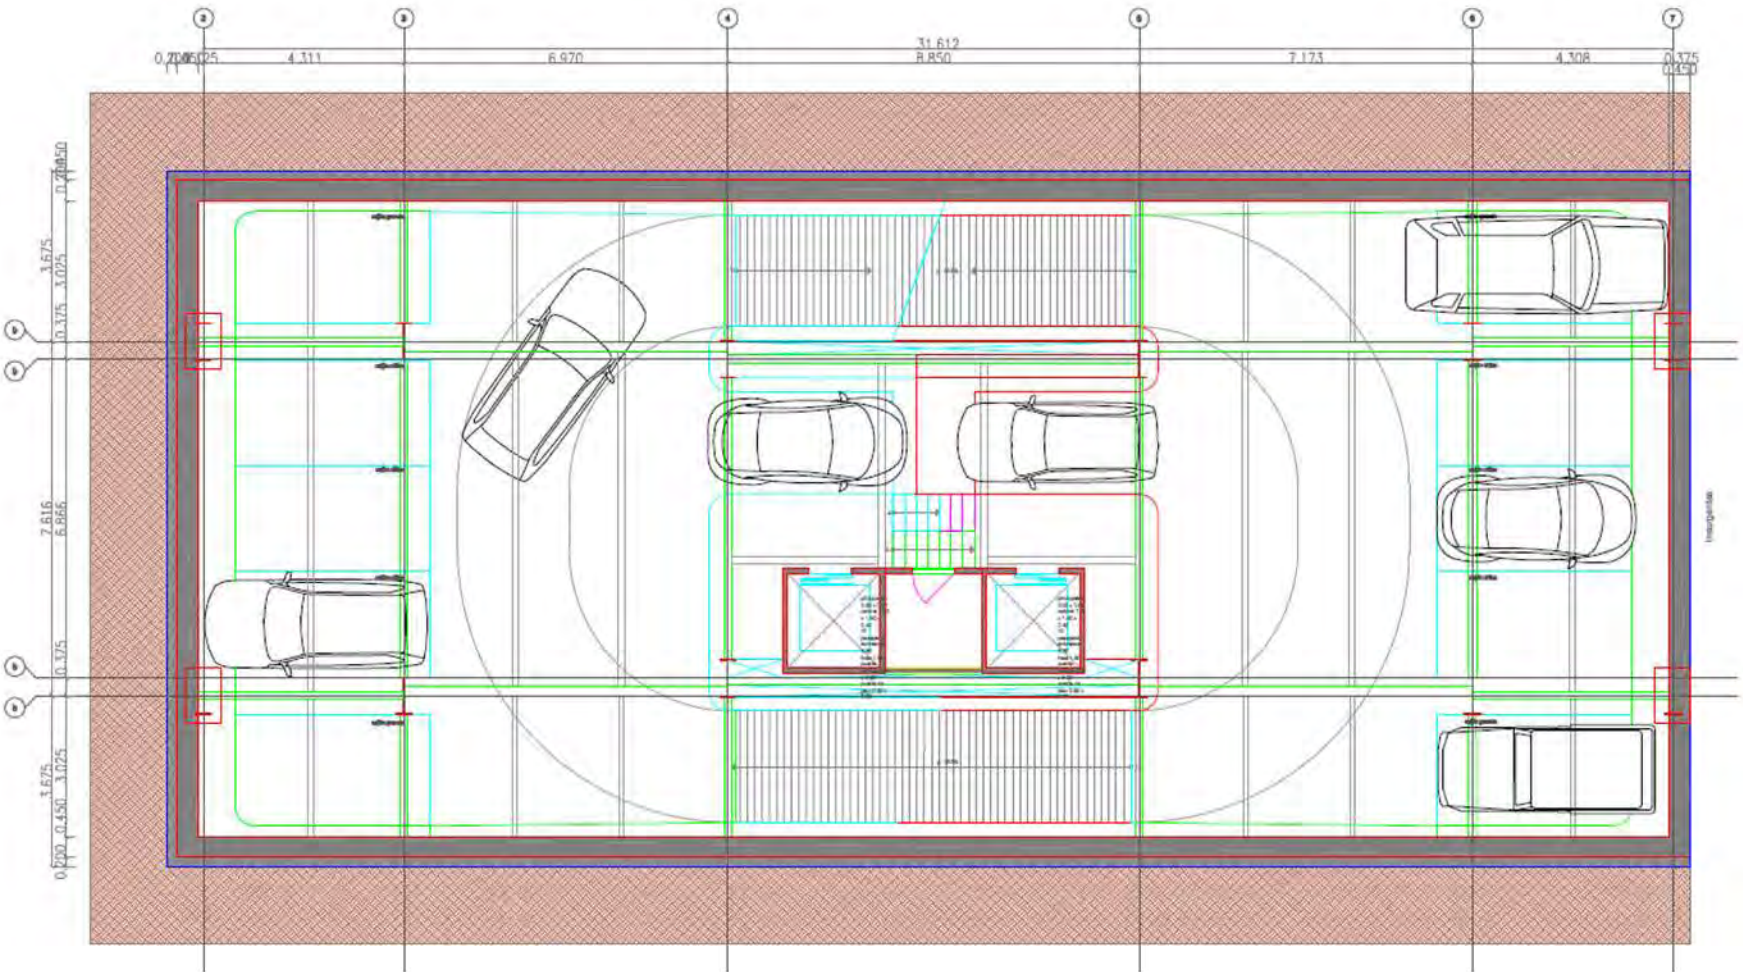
PLANTA TIPO SÓTANO (ESTACIONAMIENTO)
